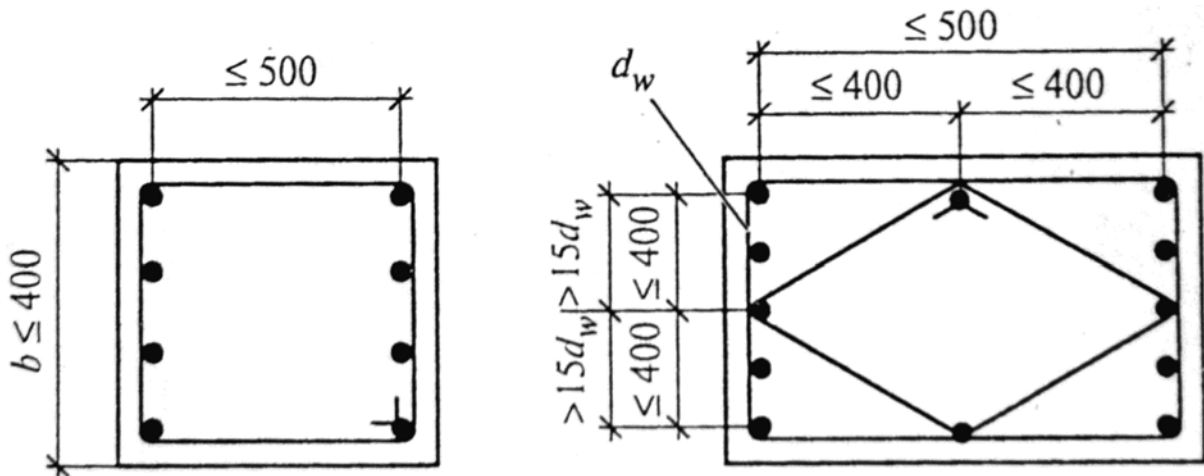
Конструкция пространственных арматурных каркасов сжатых элементов
